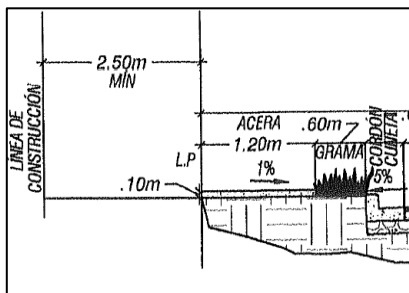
Detalle de acera. Fuente: Planos de anteproyecto
